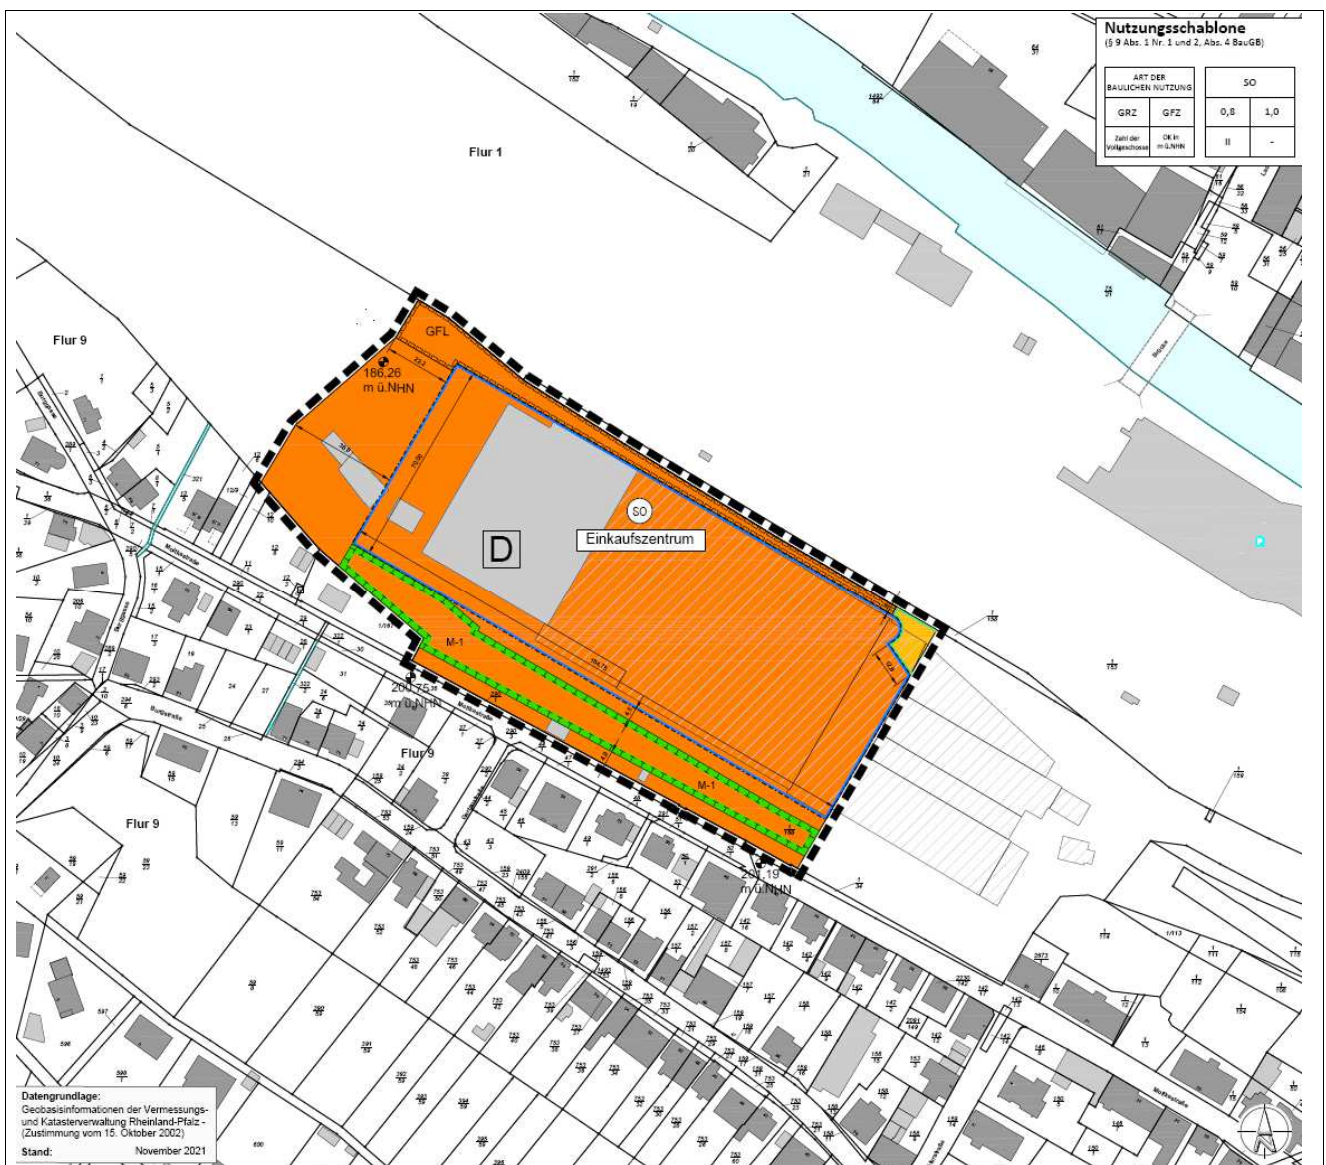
Plangebiet, Bebauungsplan-Entwurf Mitte (Planteil).
